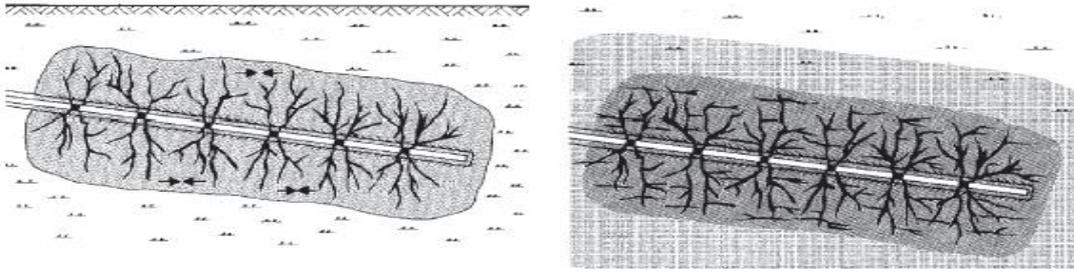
Vertikale Rissbildung bei Erstinjektion und horizontale Rissbildung bei Folgeinjektion¹⁷⁷
